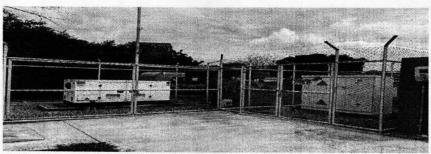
Vista general área el sistema eléctrico. Fuente: Propia
